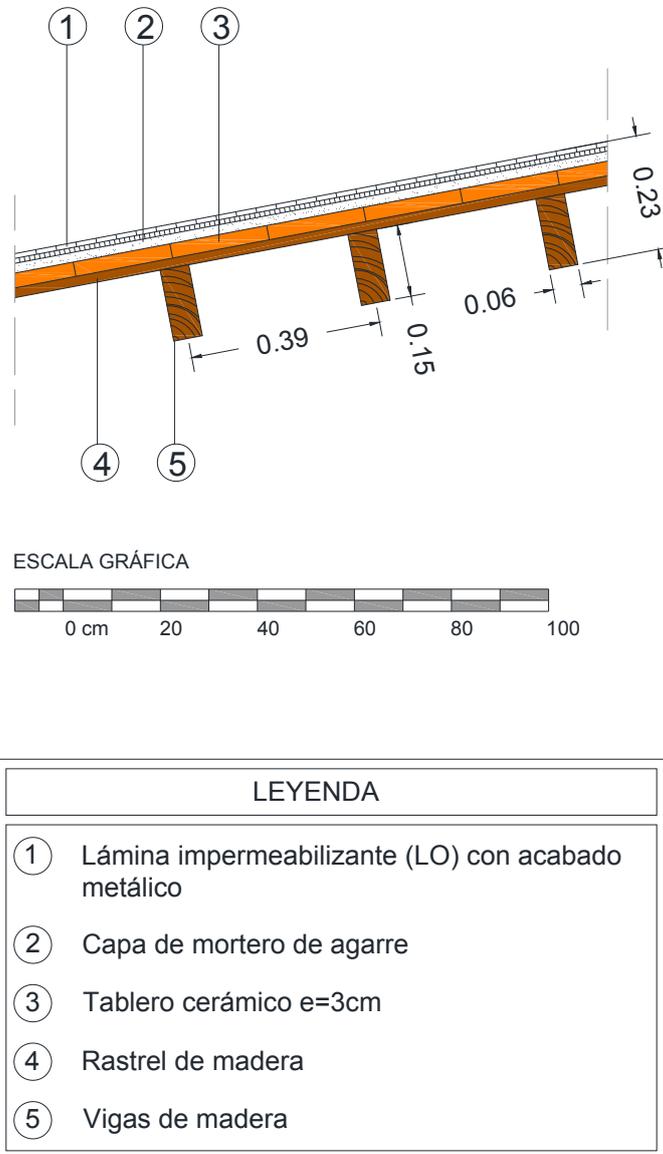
Cubierta inclinada acabada con lámina impermeabilizante
